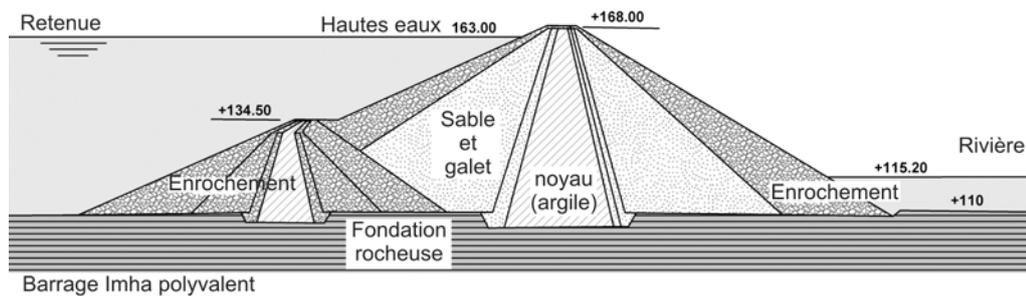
Barrage d'Imha en Corée du Sud (source : KOWACO)
